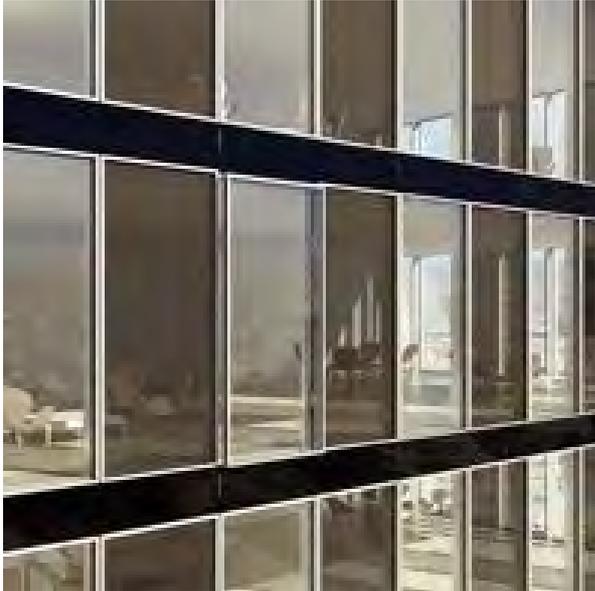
Fassade mit transparenten Photovoltaikerelementen; Quelle:
